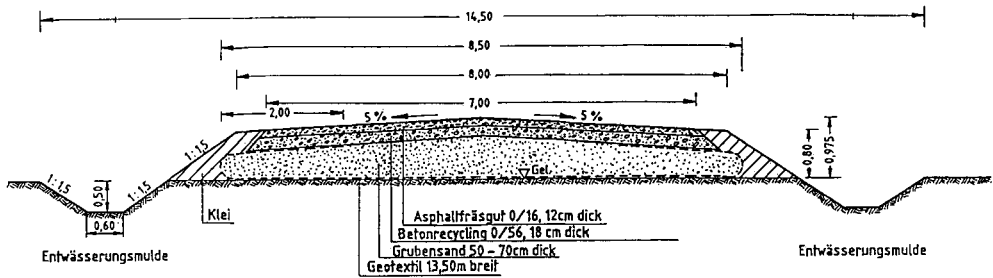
Querschnitt einer Baustraße in Nordfriesland unter Verwendung eines Kunststoff-Gewebes
